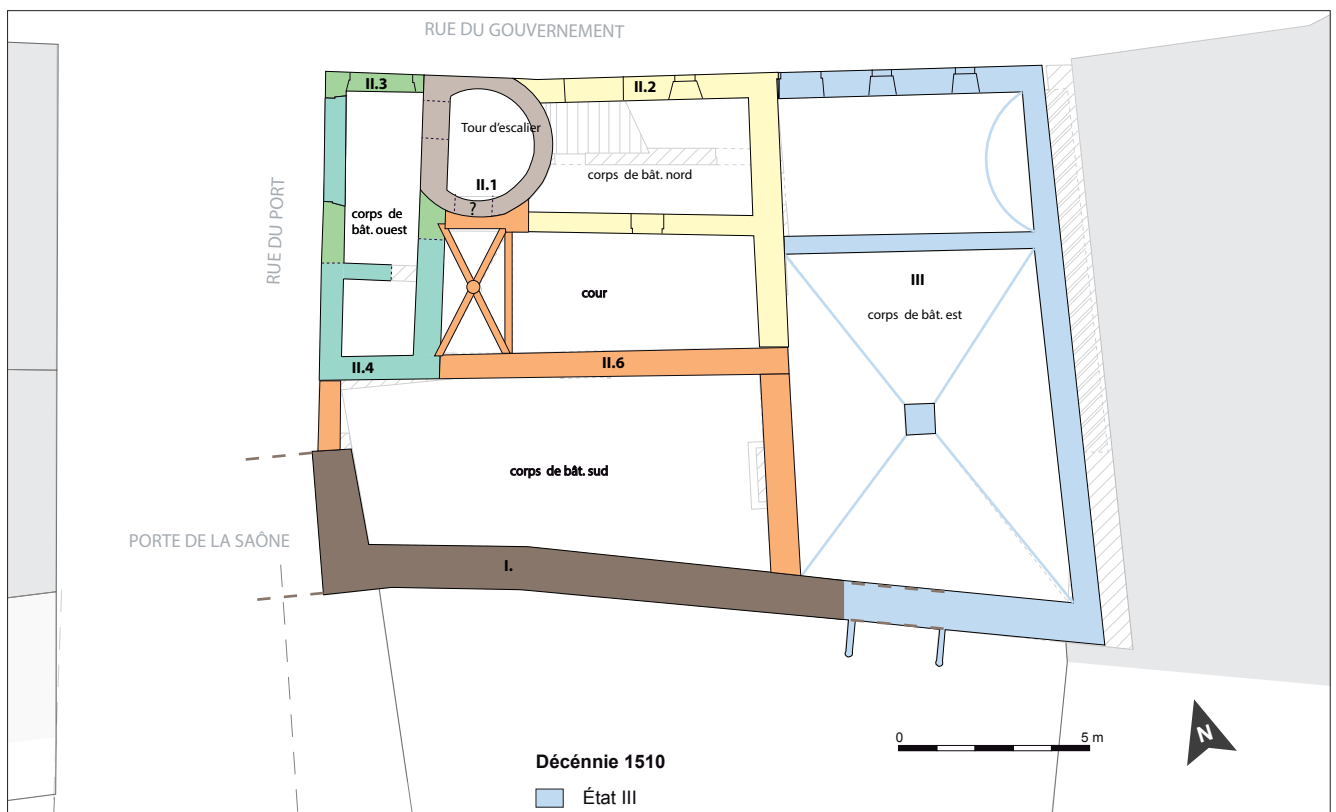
Illustration Q : État III : Restitution en plan du corps de bâtiment est - (éch. : 1/200).
